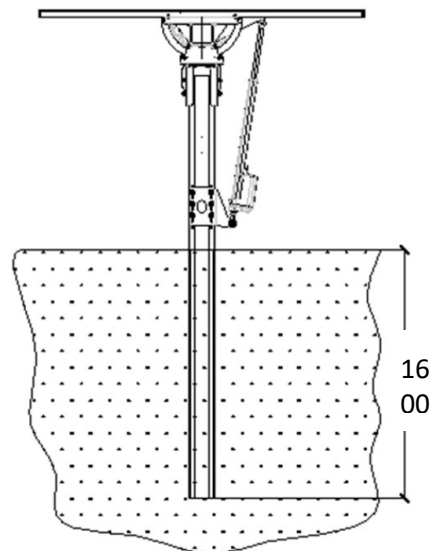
TIPO E LUNGHEZZA DI INFISSIONE
